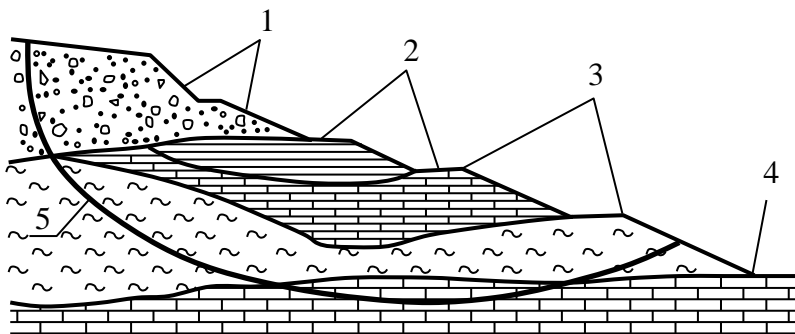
Схема ґрунтового укоса та його основних частин: 1 – уступ; 2 – берма; 3 – бровка уступу; 4 – подошва укосу; 5 – поверхня ковзання
